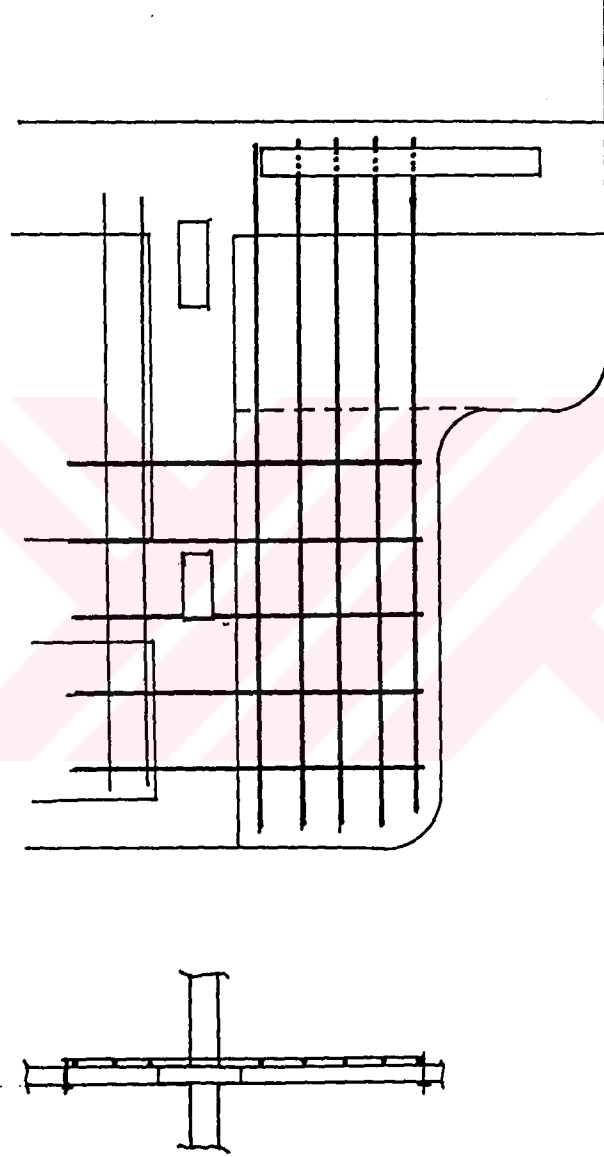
Nervürlü döşemede ek kirişler ve ek donatılar
